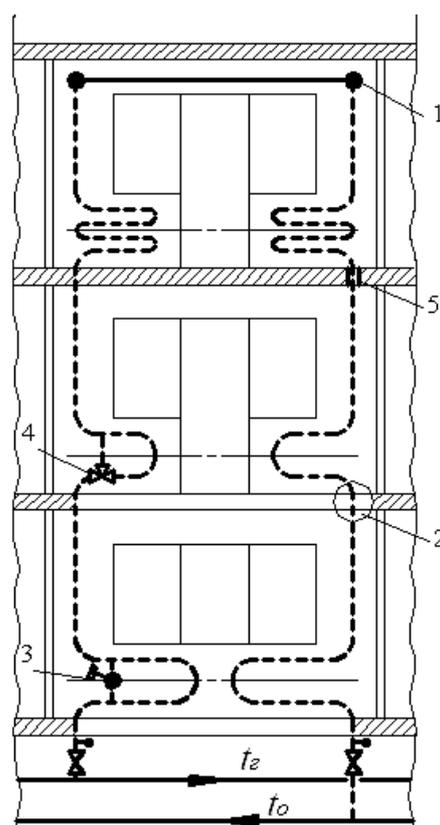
Схема панельной системы отопления крупнопанельных зданий: 1 – воздухоотводчик; 2 – монтажный стык; 3 – кран двойной регулировки; 4 – трехходовой кран; 5 – гильза
